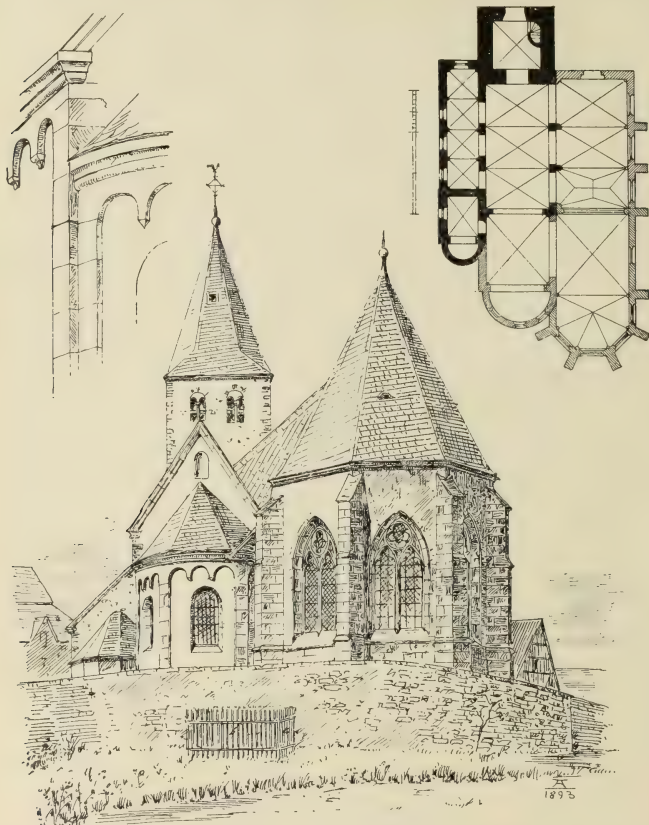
Frauenberg, Katholische Pfarrkirche. Choransicht, Grundriss und Detail.
